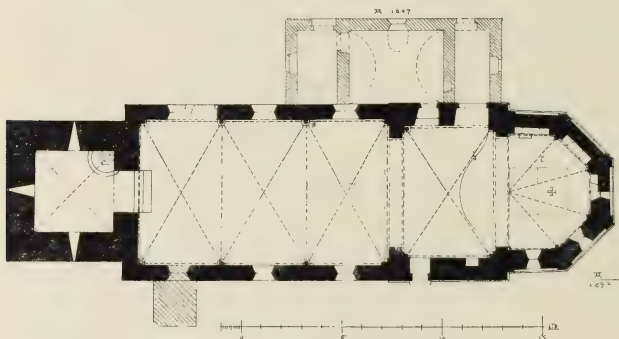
Lützelberg Kathol. Pfarrkirche. Grundriss.
